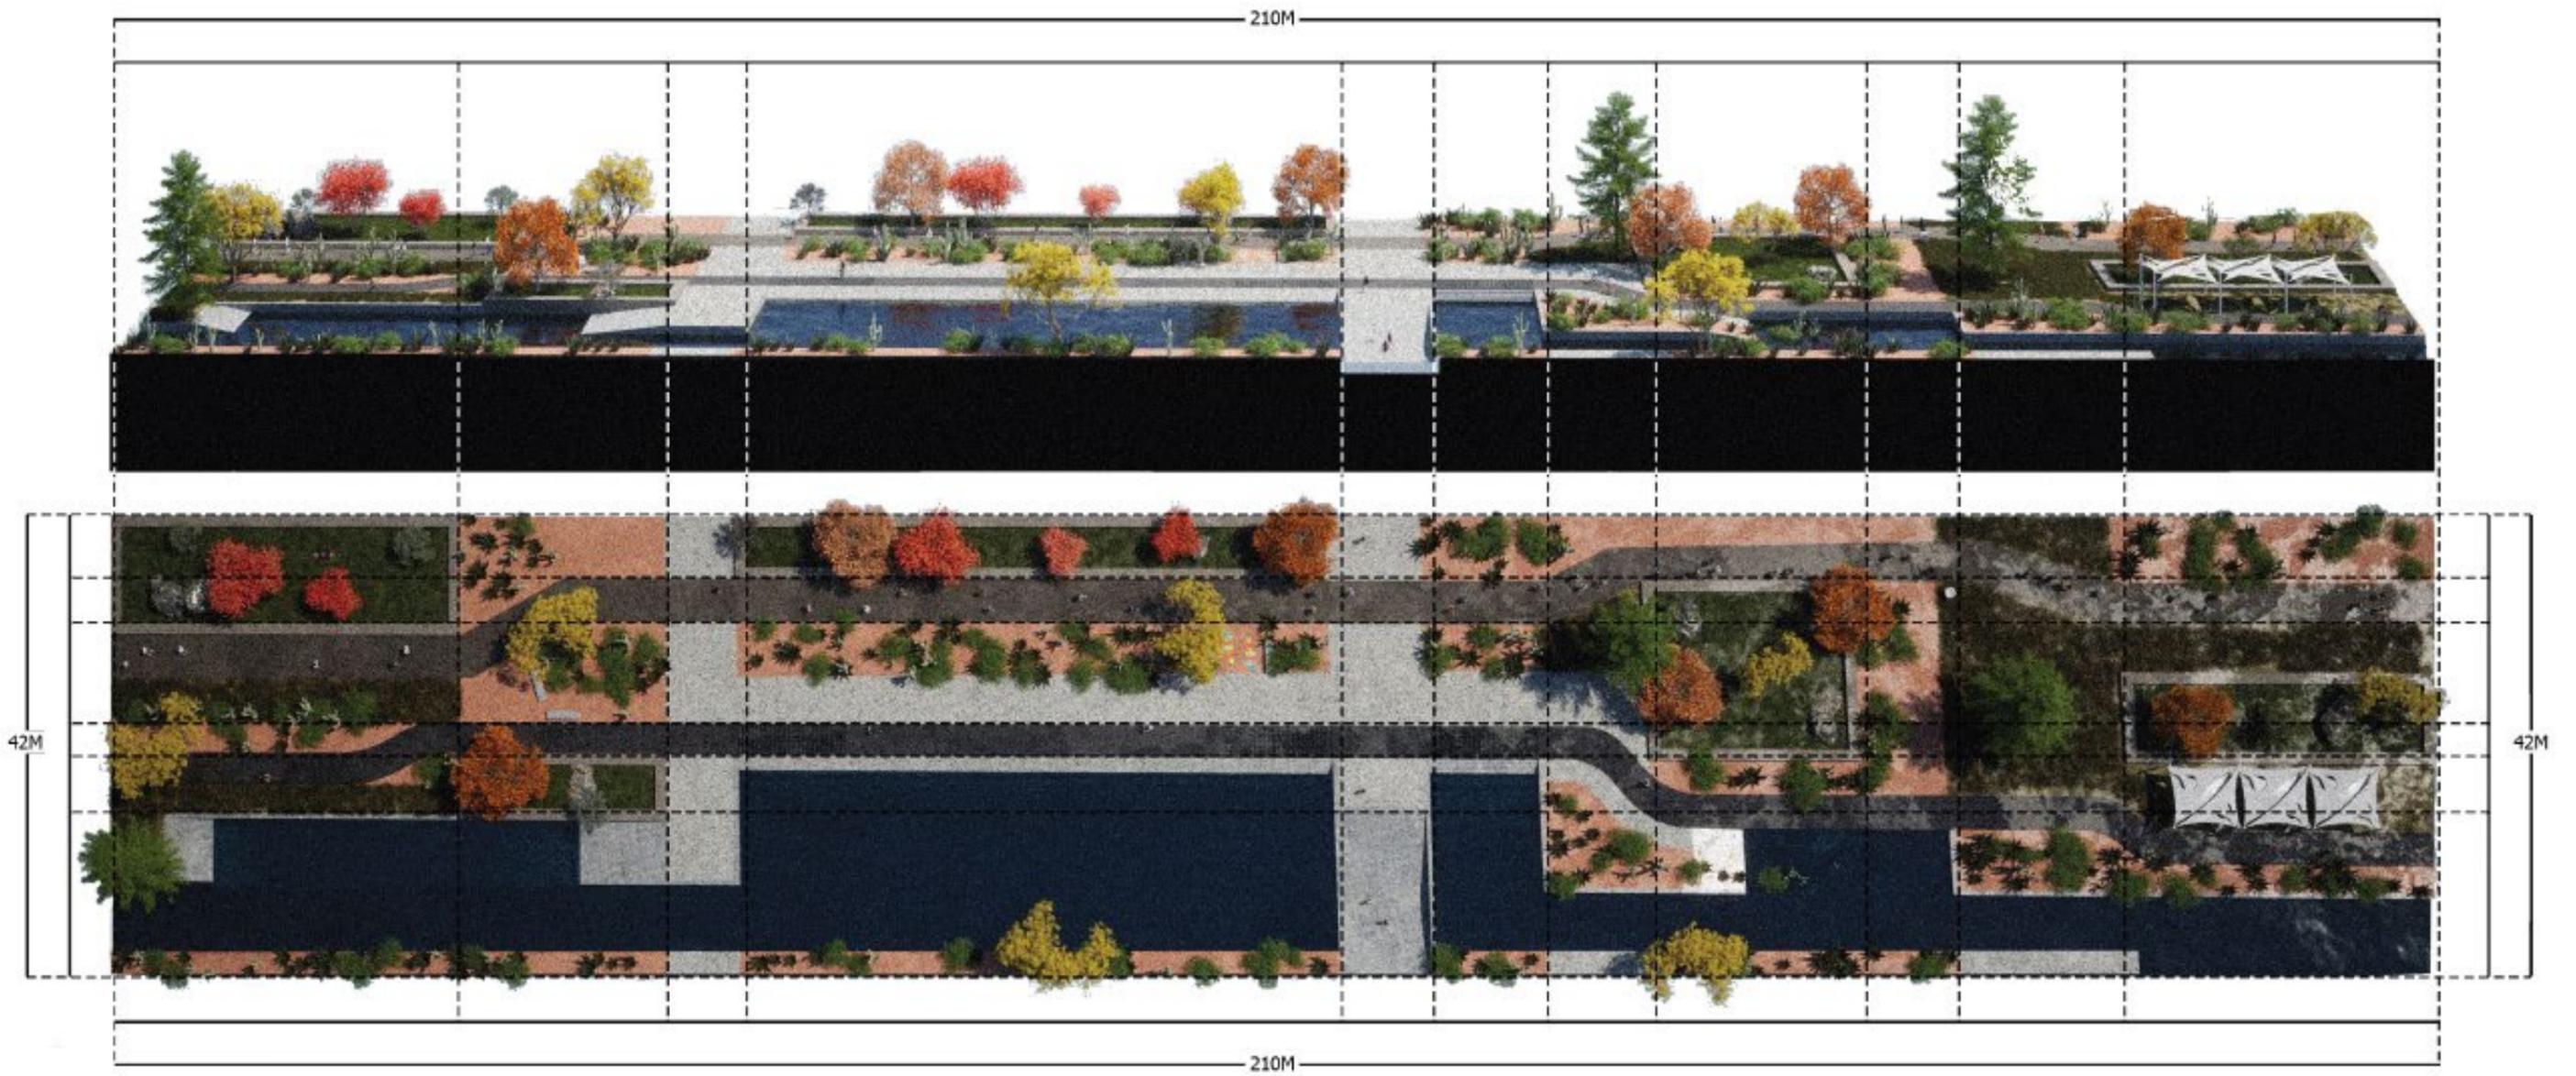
Planimetría parque en época invernal. Fuente: Elaboración propia
